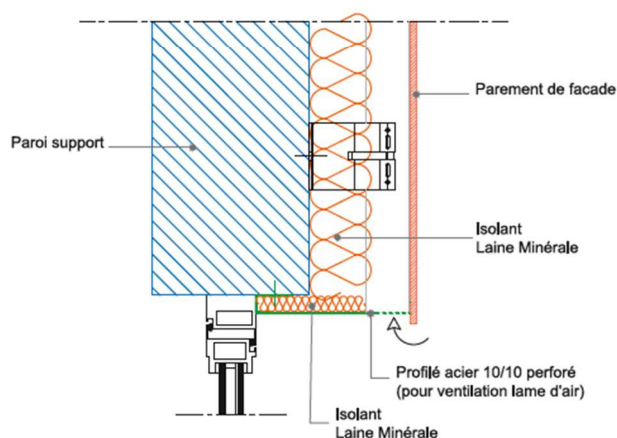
Coupe verticale encadrement de la baie niveau linteau
